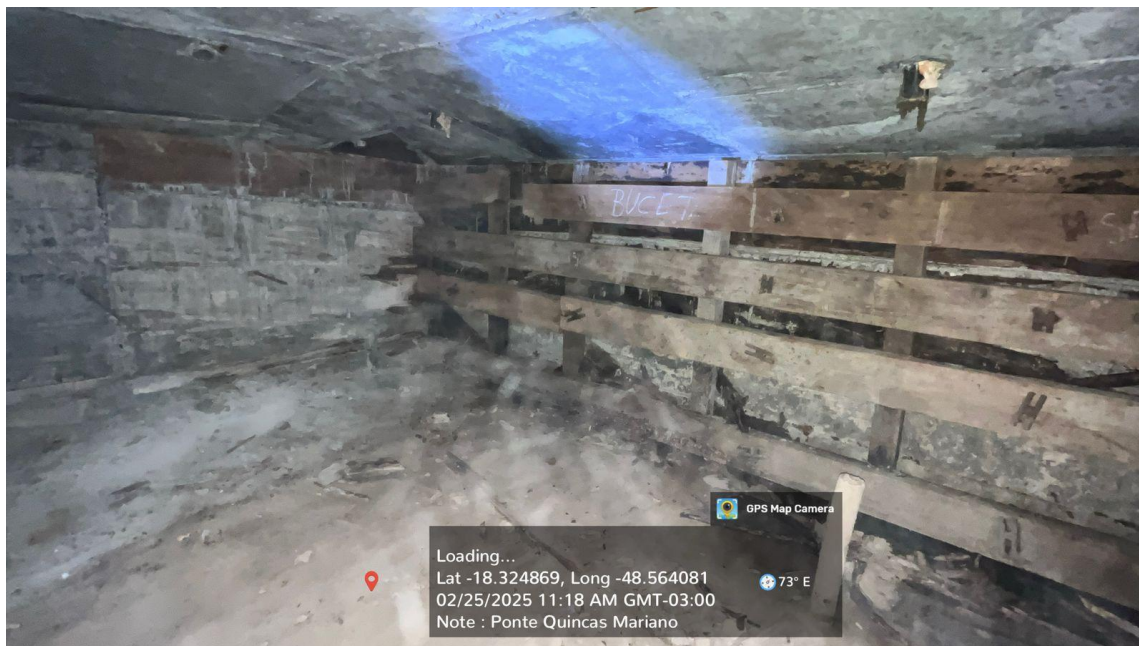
Madeiras de formas, provavelmente, da época da construção, que deverão ser removidas durante a execução das obras de reabilitação
